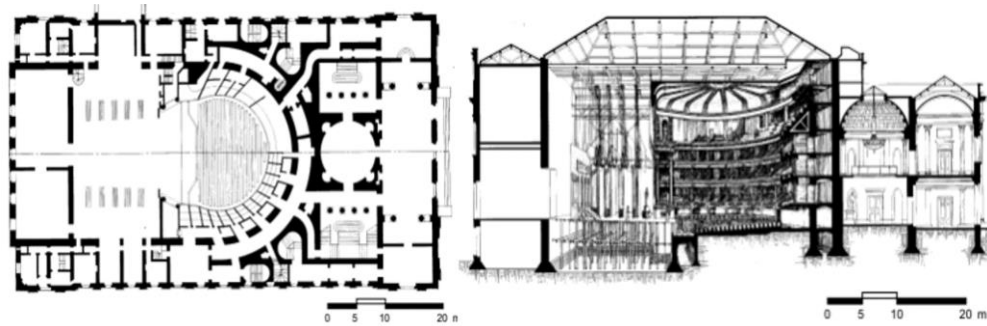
Planta y sección del Teatro Drury Lane. Adaptado de Diseño acústico de espacios arquitectónicos.
